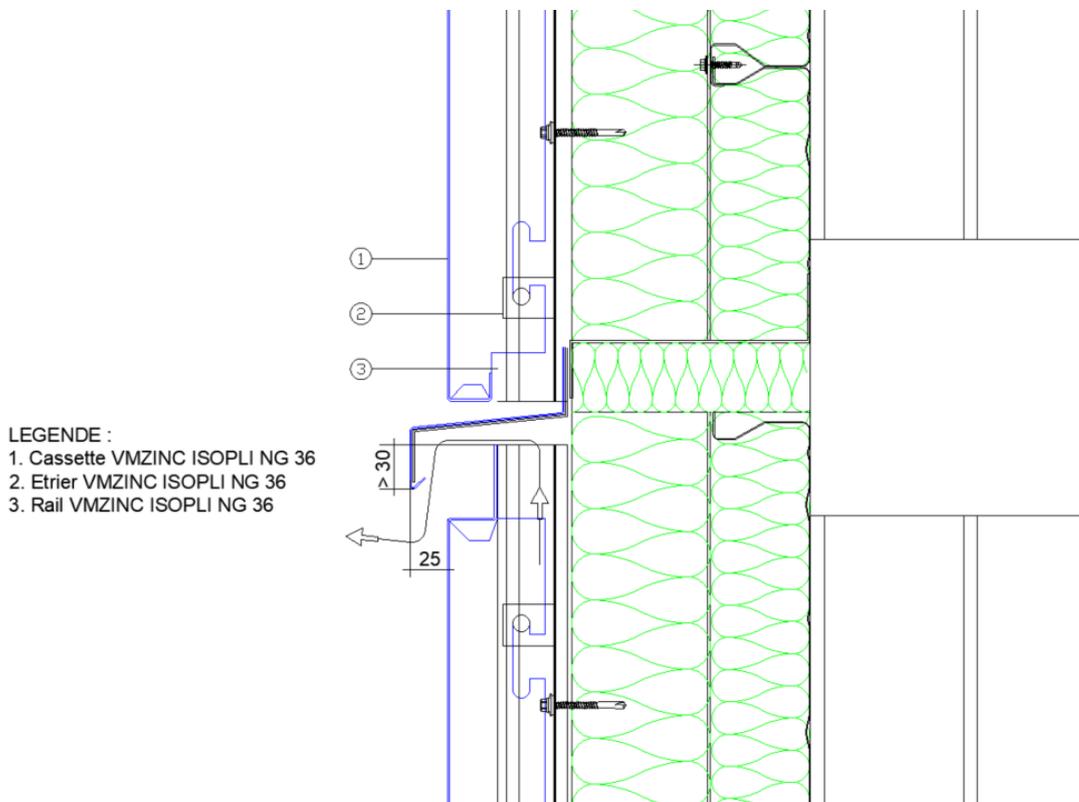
Fractionnement horizontal de la lame d’air et recoupement du pare pluie tous les 3 m sur plateaux
